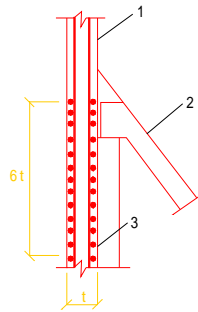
仓壁底部水平钢筋延续配置范围示意图
